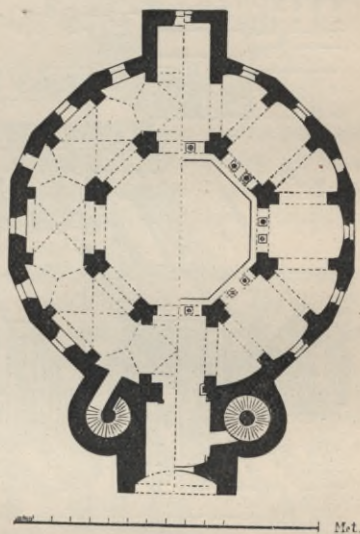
Grundriss der Aachener Palastkapelle.
